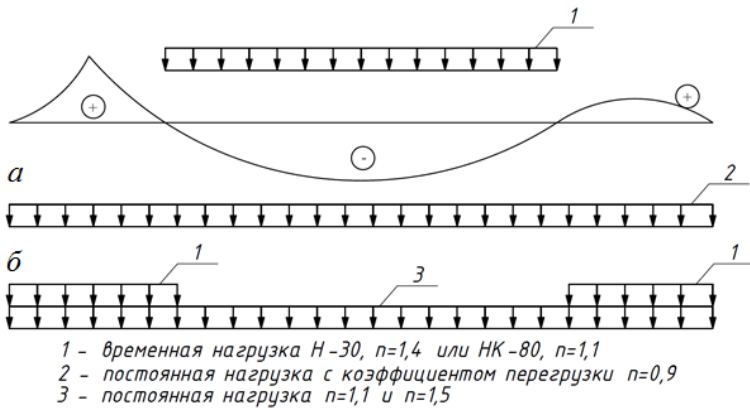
Схемы к определению нагрузки на ферму моста
